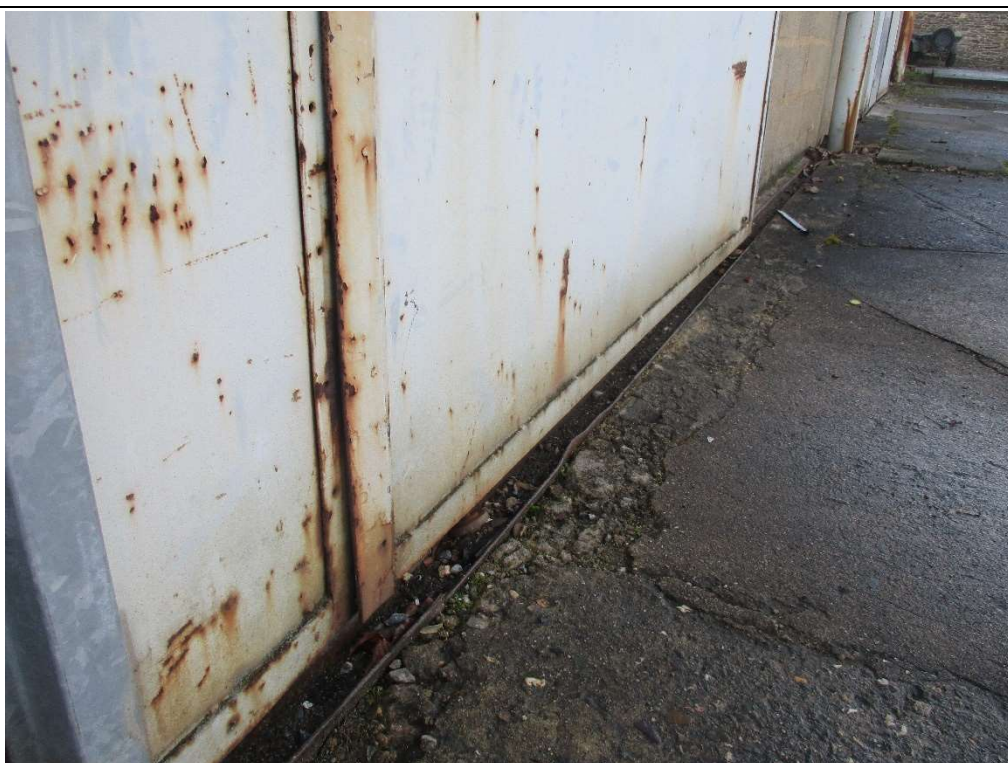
Dégradation équipement - Locaux 016 et 018, portes coulissantes
